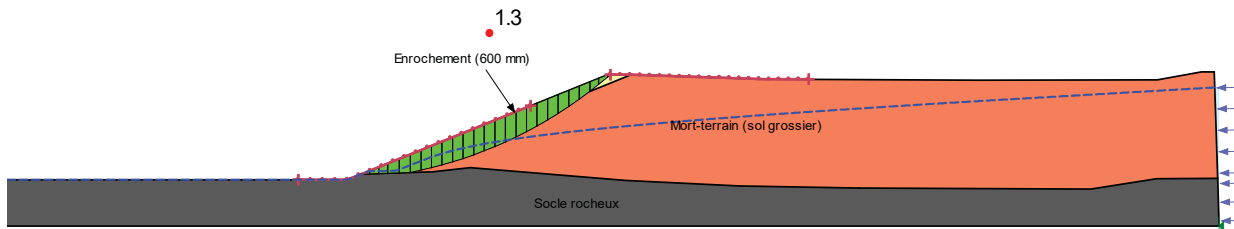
Stabilité pseudo statique, excavation dans des sols grossiers
